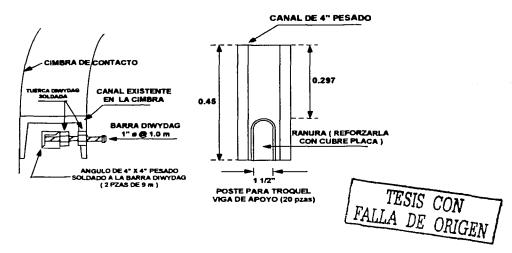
Croquis del dispositivo de apoyo de la cimbra
